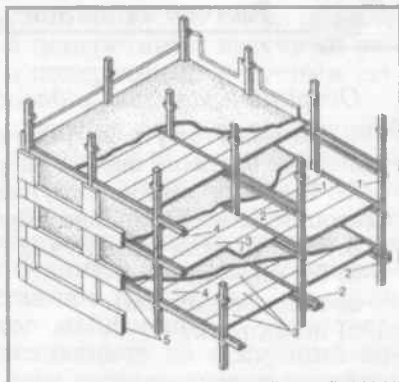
Схема каркасу багатоповерхового промислового будинку:
